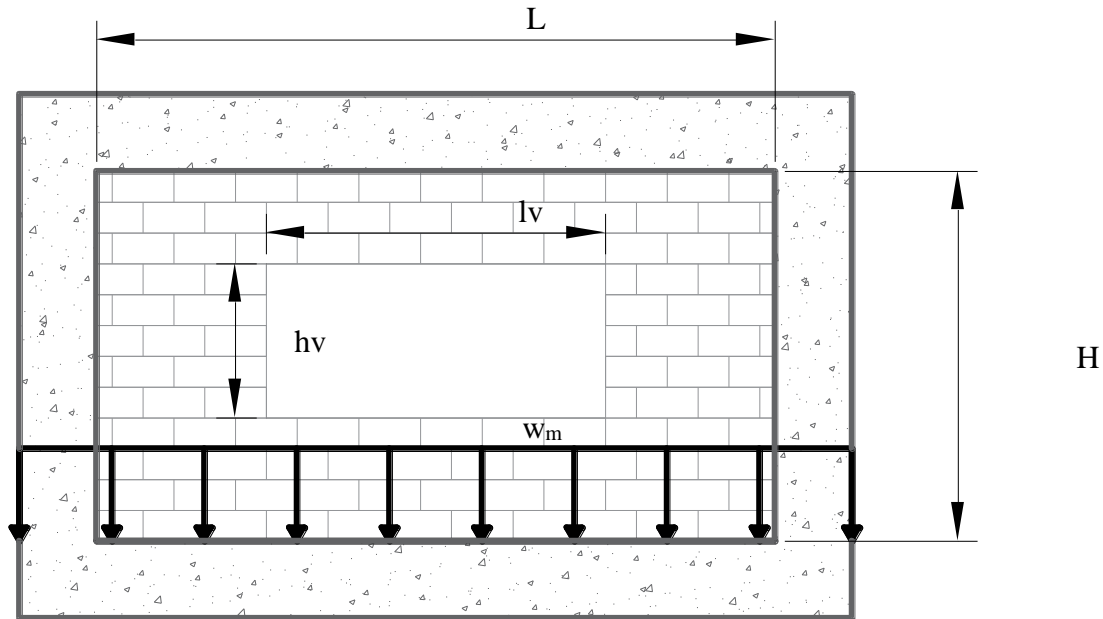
Carga distribuida en la viga resultante del peso del muro de mampostería no estructural asentado sobre esta.
